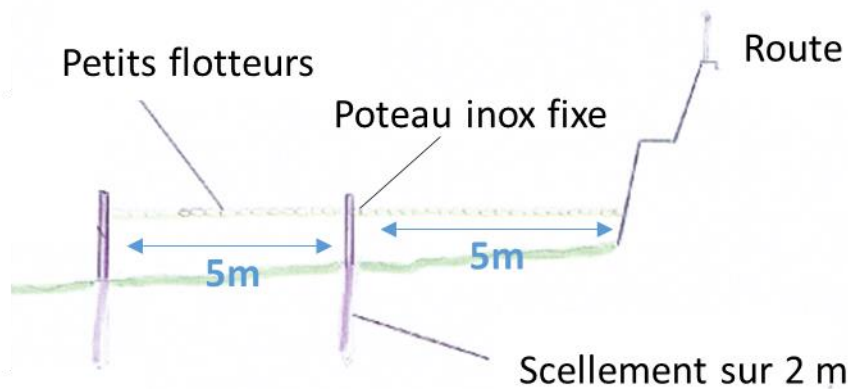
Exemple d'implantation des poteaux en inox fixes
